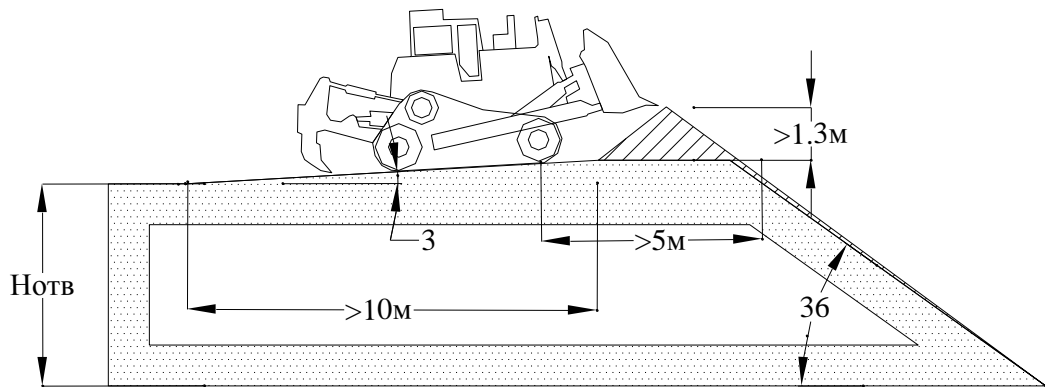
Формирование разгрузочной площадки отвала бульдозером SD-22
